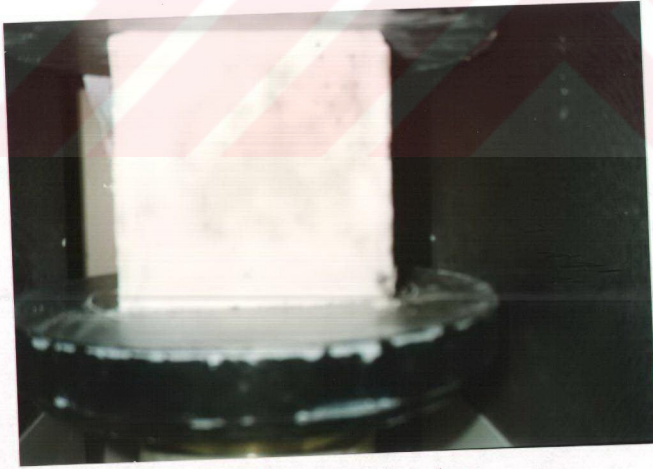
Deneilerde kullanılan malzemelerin görünüşü
